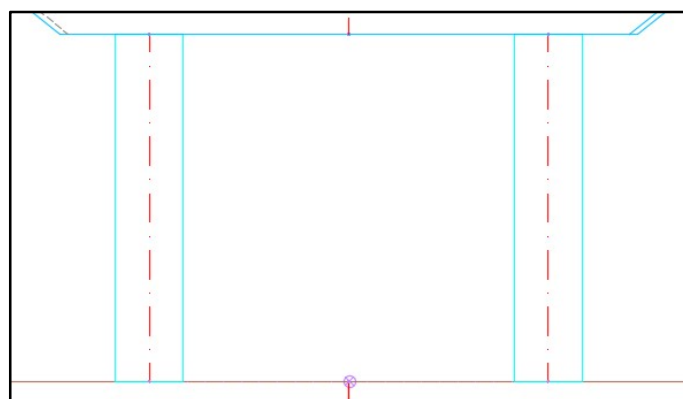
Alzado de los fustes de las pilas intermedias.
